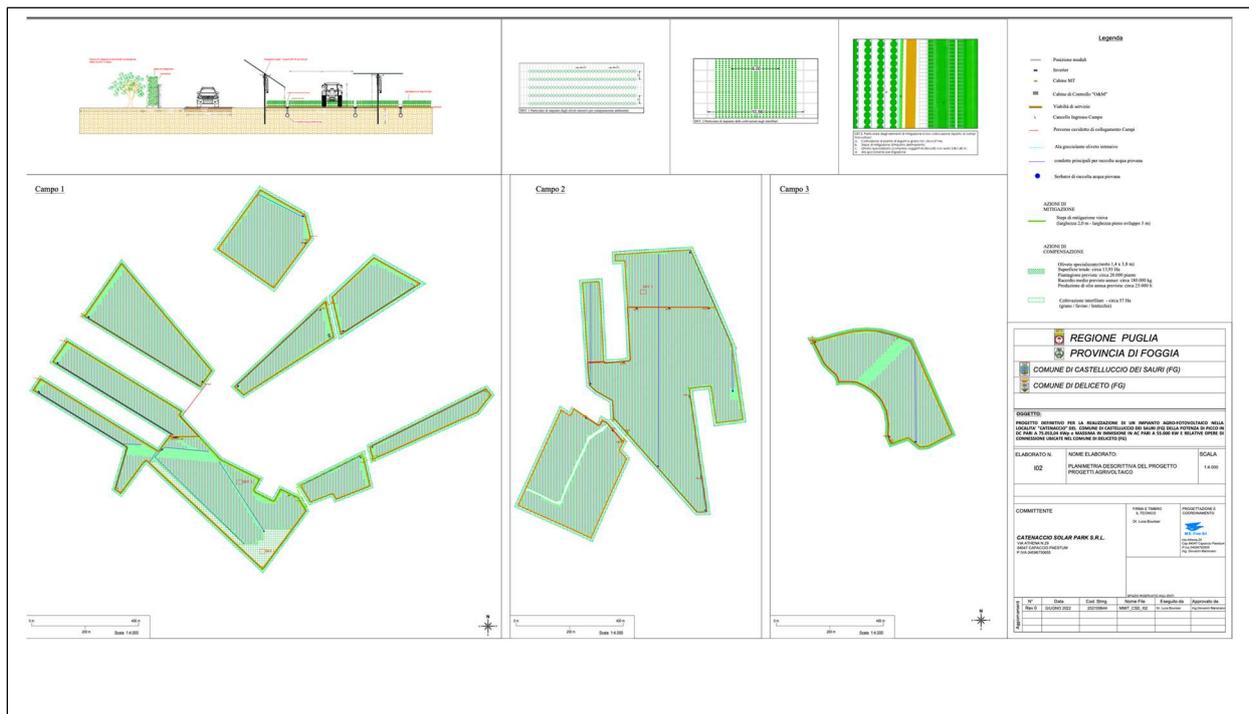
Rappresentazione mitigazione Campo 1-2-3
